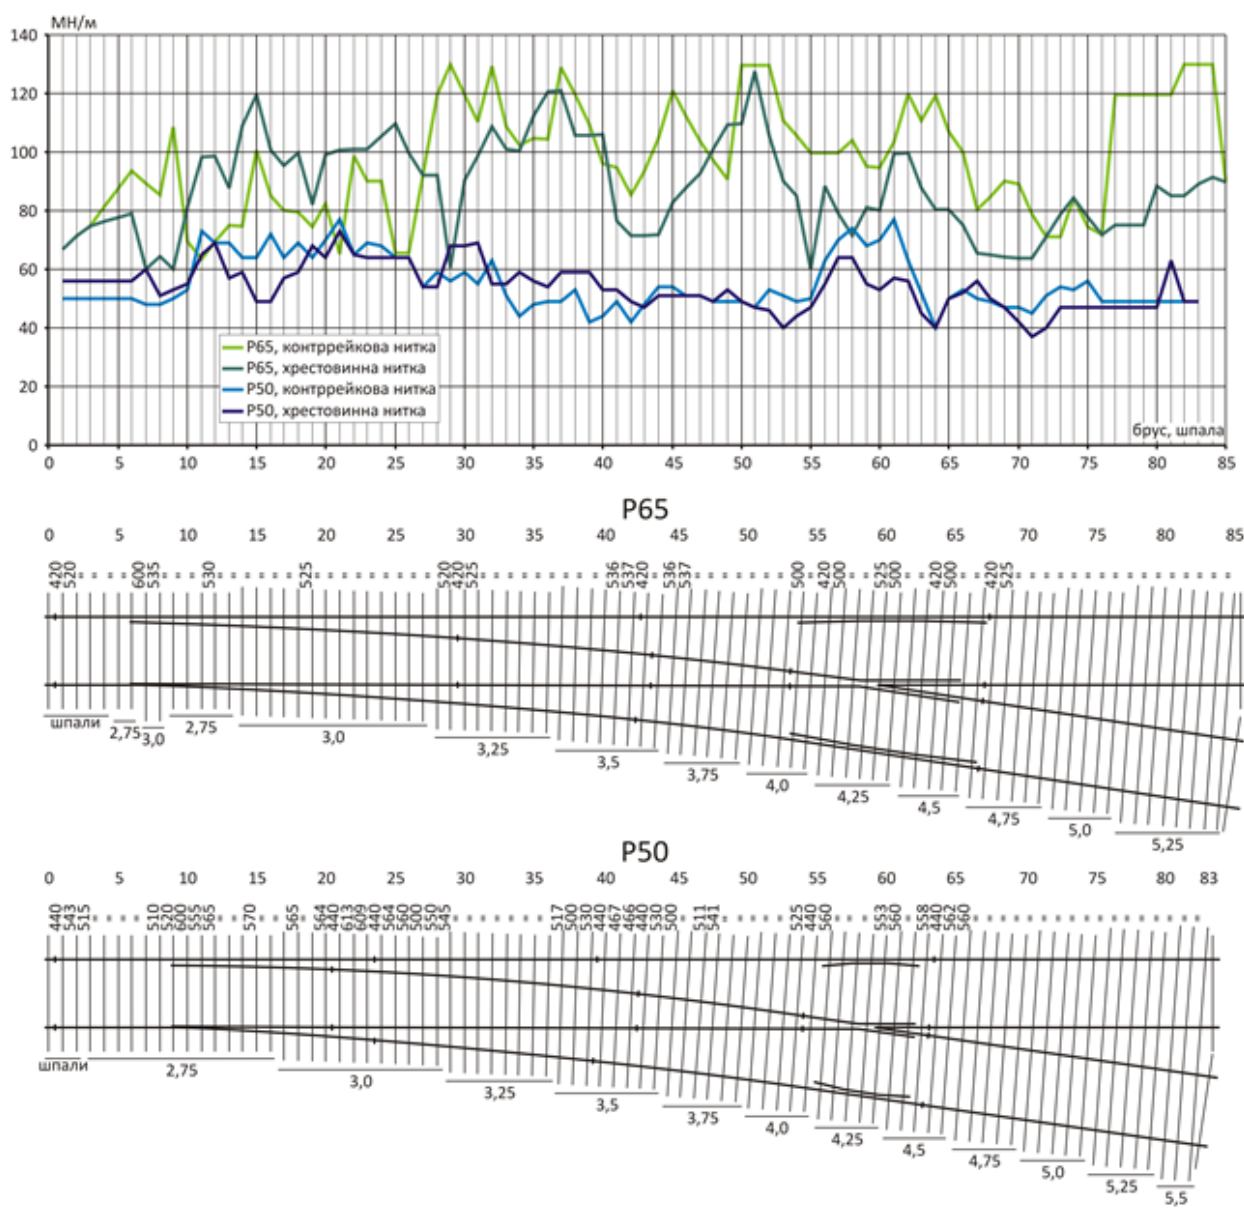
Вертикальна жорсткість дослідних стрілочних переводів типів P50 і P65 на залізобетонних брусах (прямий напрямок)
